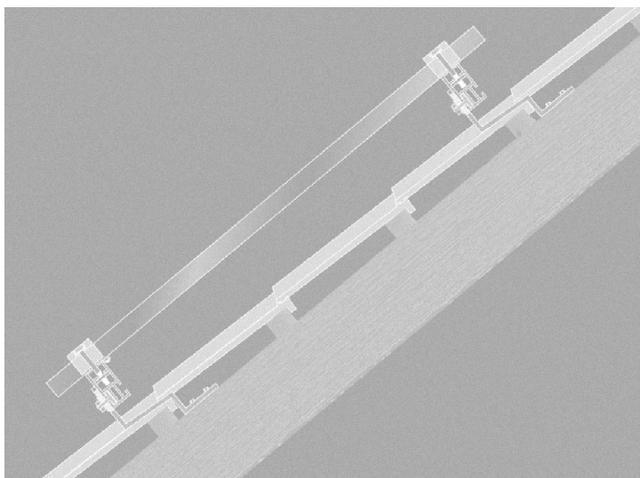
Composição Geral: Gancho do telhado; Módulo FV com armação; Apoio do módulo; Barra da guia; Estrutura do telhado.
